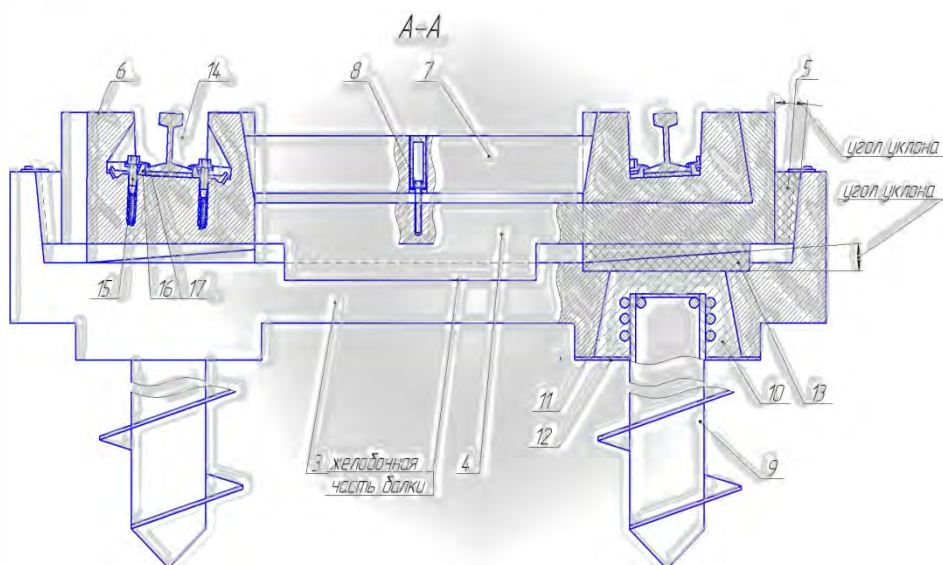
Сечение А-А предлагаемого ЛРТ-пути: 3 – поперечная балка, 4 – опорная балка, 5 – эластичные элементы, 6 – лежневый блок, 7 – распорная балка, 8 – винтовая стяжка, 9 – свайные опоры, 10, 11 – фиксирующие бетонные блоки в отверстие, 12 – металлическая опалубка, 13 – парные эластичные опорные элементы, 14 – желоба лежневых блоков, 15, 16, 17 – крепления рельсового пути [выполнено авторами].
